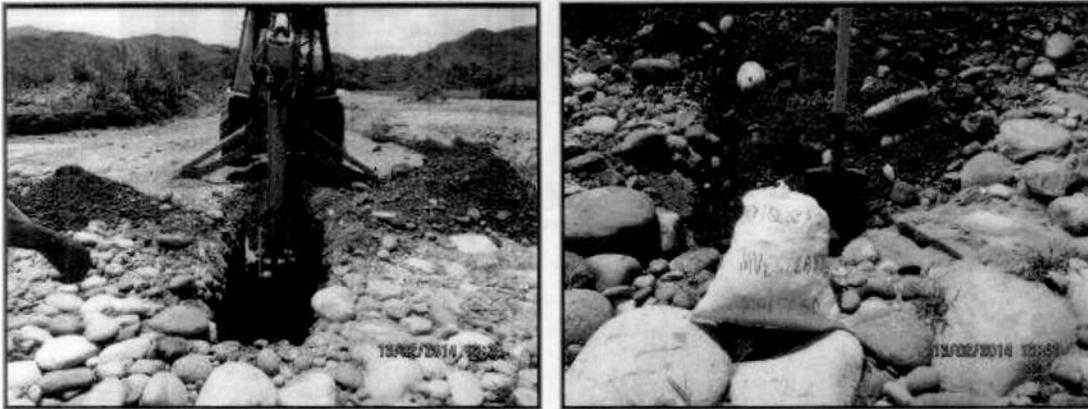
Detalle del apique 1 excavado para la toma de la muestra 1, en la terraza baja.
